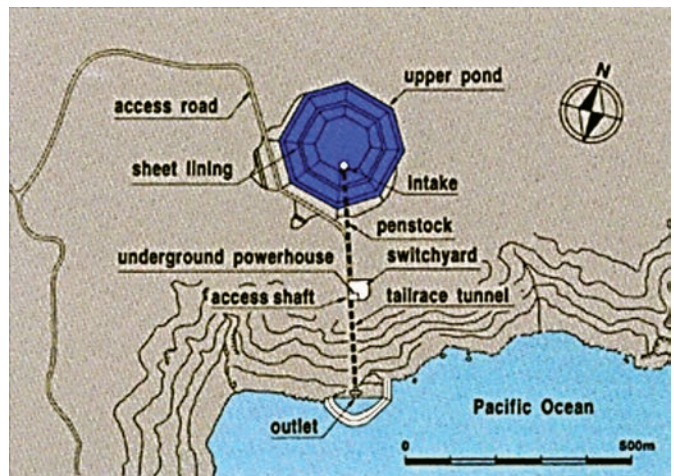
План расположения сооружений станции «Окинава»: upper pond — верхний резервуар, access road — подъездная дорога, sheet lining — лист резинового покрытия дна, intake — вход воды, penstock — напорный туннель, underground powerhouse — подземный комплекс гидростанции, switchyard — распределительное устройство, access shaft — ствол доступа, tailrace tunnel — отводящий туннель, outlet — сброс воды
